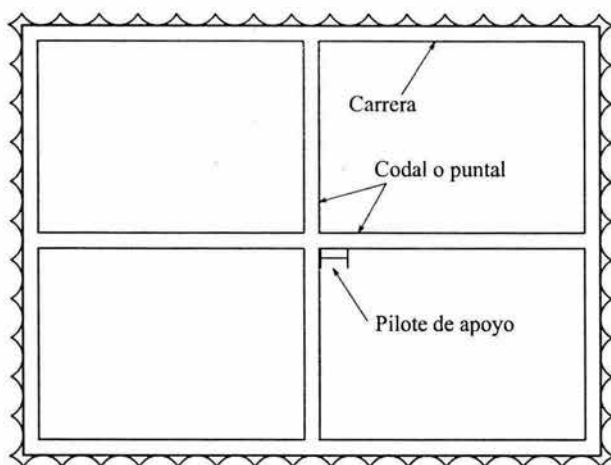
PLANTA DE ENTIBACIÓN CRUZADA
